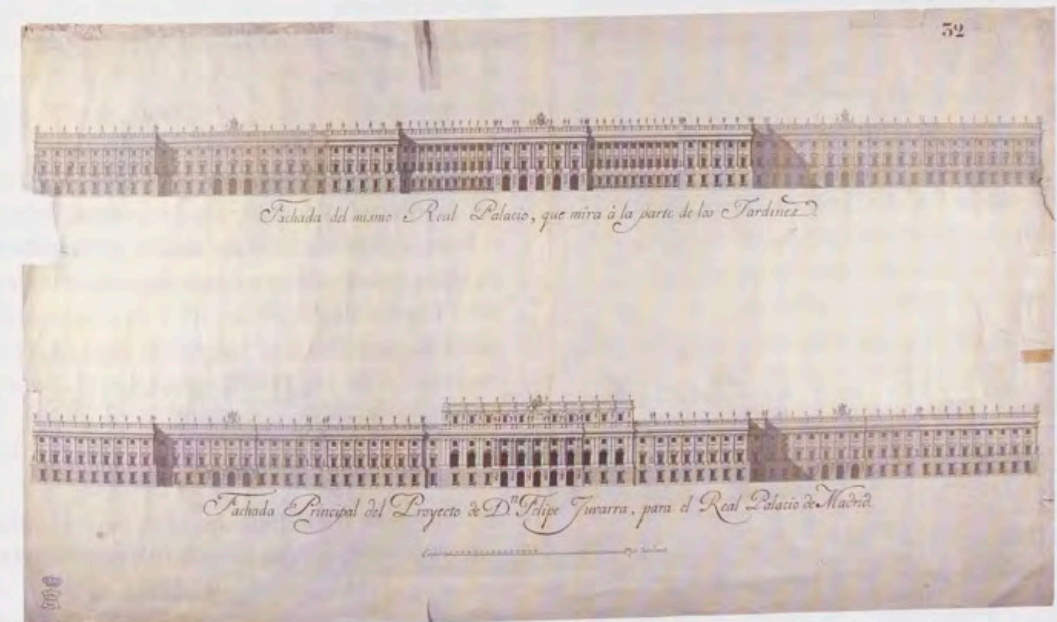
Atribuido a Marcelo Fontón, Proyecto de Filippo Juvarra para el Palacio Real de Madrid, Alzados de la fachada norte a los jardines y principal, AGP, Planos, 76, Madrid, Patrimonio Nacional.
